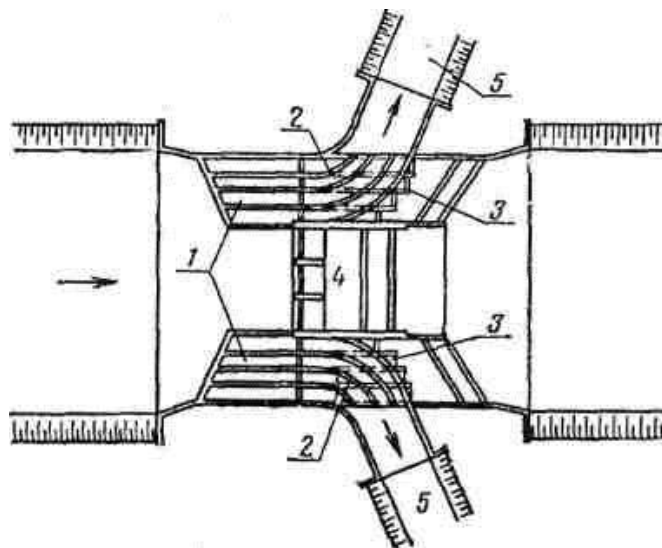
Фронтальный двухъярусный водозабор:
